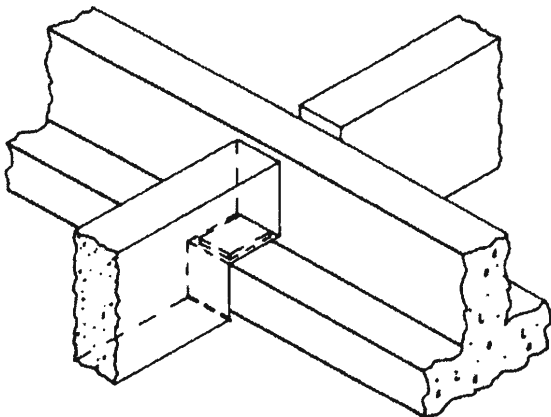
Conexión típica viga sobre viga. (Ref. 33)
